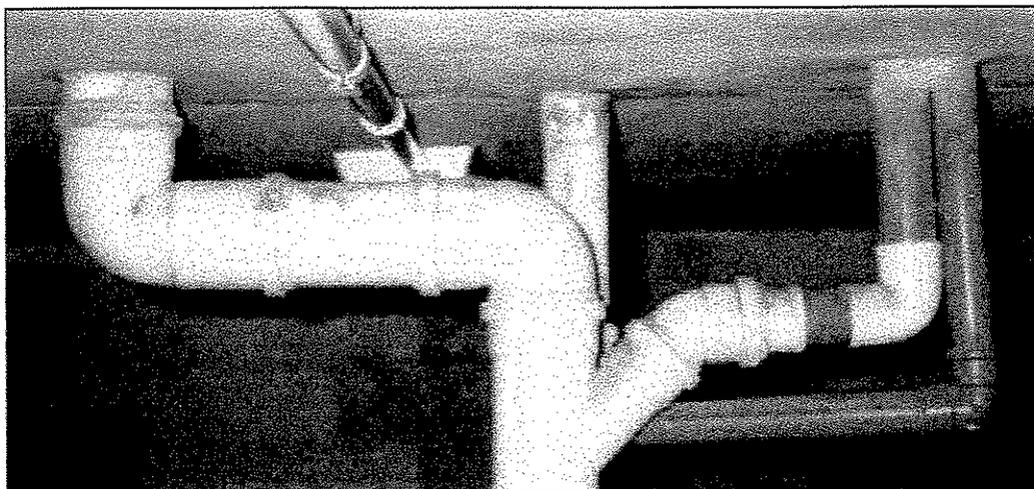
Detalhe da ligação do sistema de extravasão.
